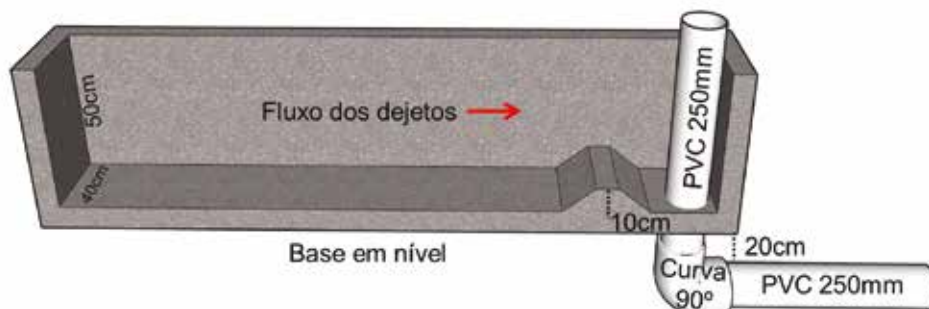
Detalhe das dimensões de um sistema de calha para manejo de dejetos bovinos
